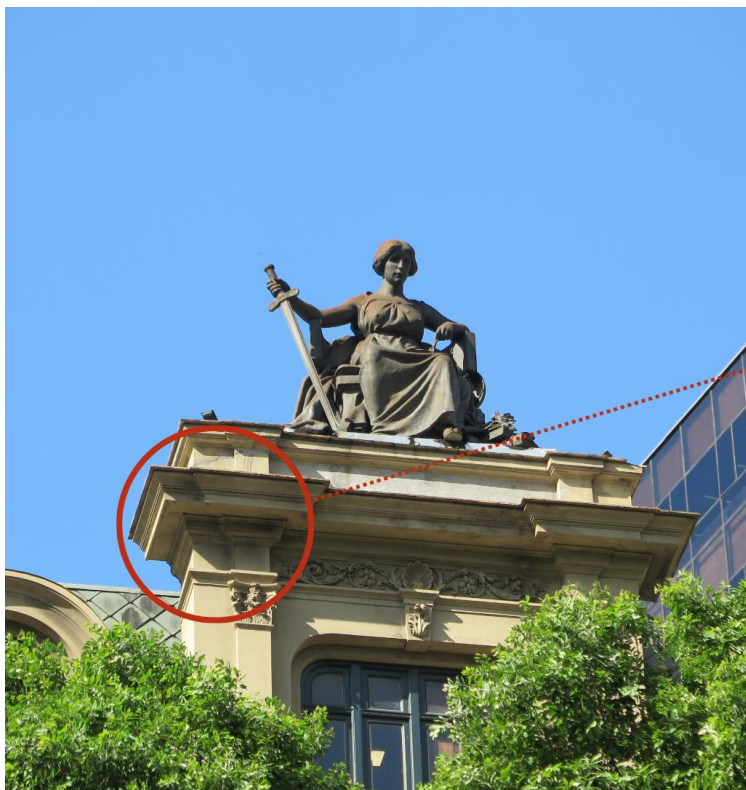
Danos Gerais levantados: Elementos Arquitetônicos quebrado.
